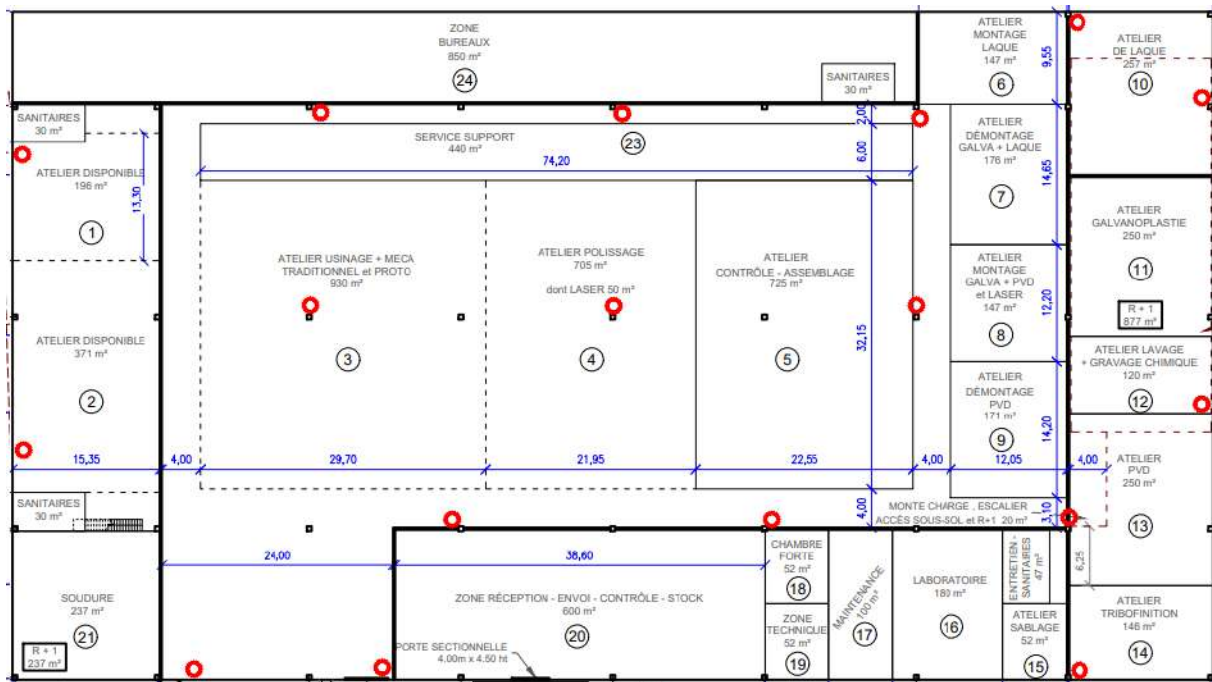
PLAN D'IMPLANTATION DU RESEAU RIA (RONDS ROUGES)
